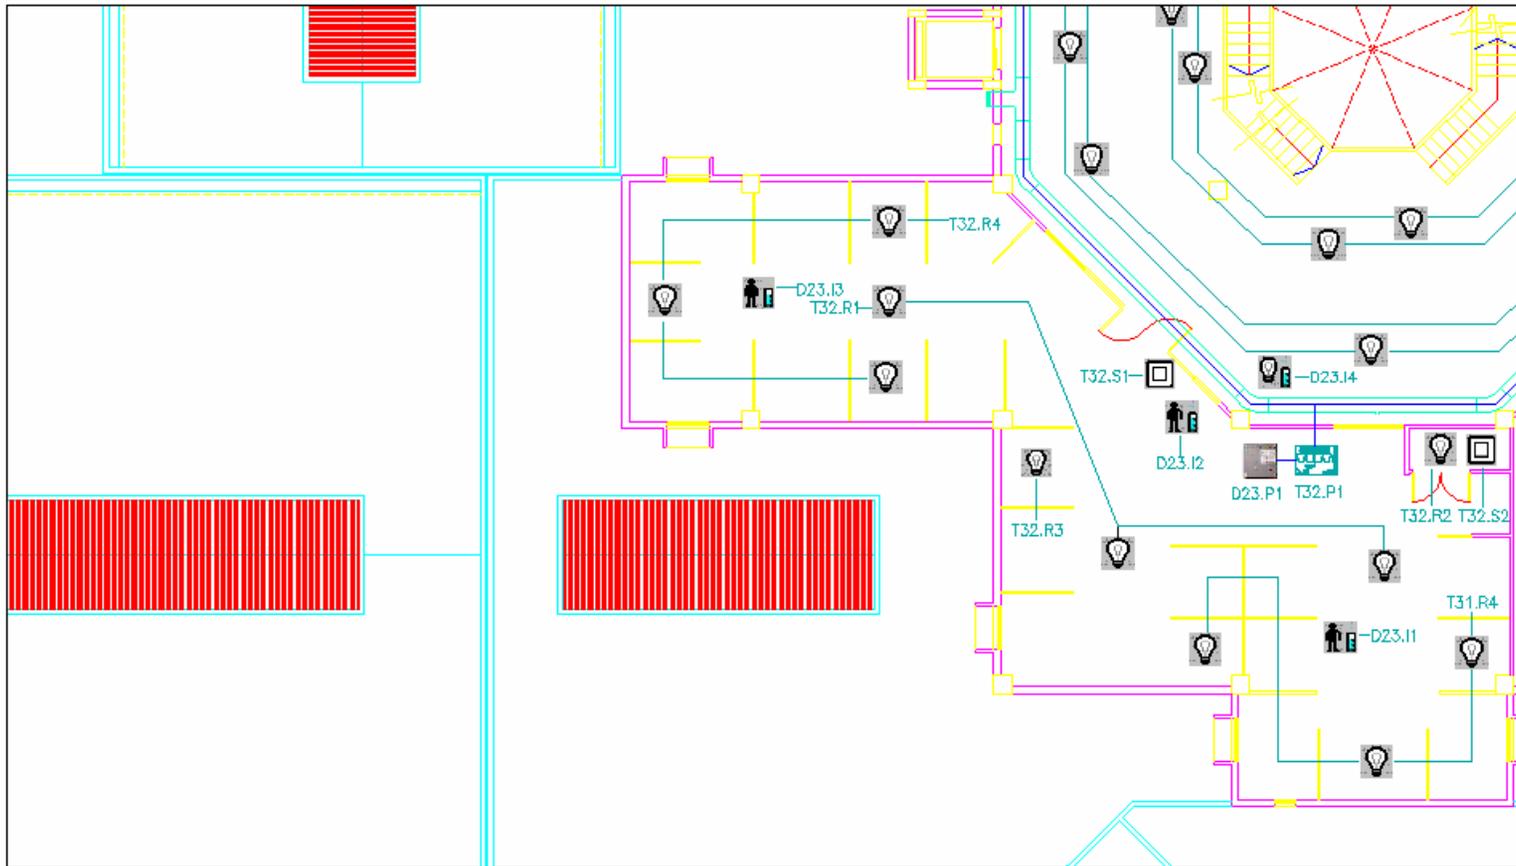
PLANO ILUMINACION PRIMER PISO SECCION 1
